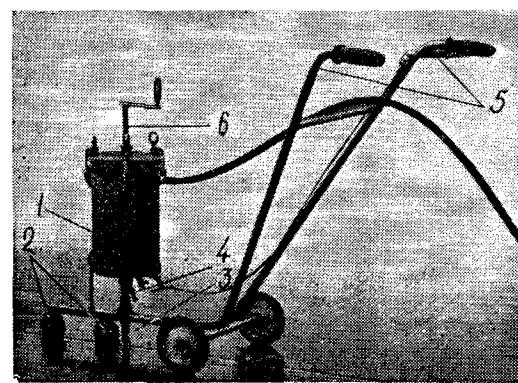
Устройство для подгрунтовки прорези шва kleющим веществом: 1 — бачок емкостью 12 л; 2 — тележка с направляющими роликами; 3 — распылитель; 4 — запорный кран; 5 — ручки управления; 6 — ручной лопастной вал
